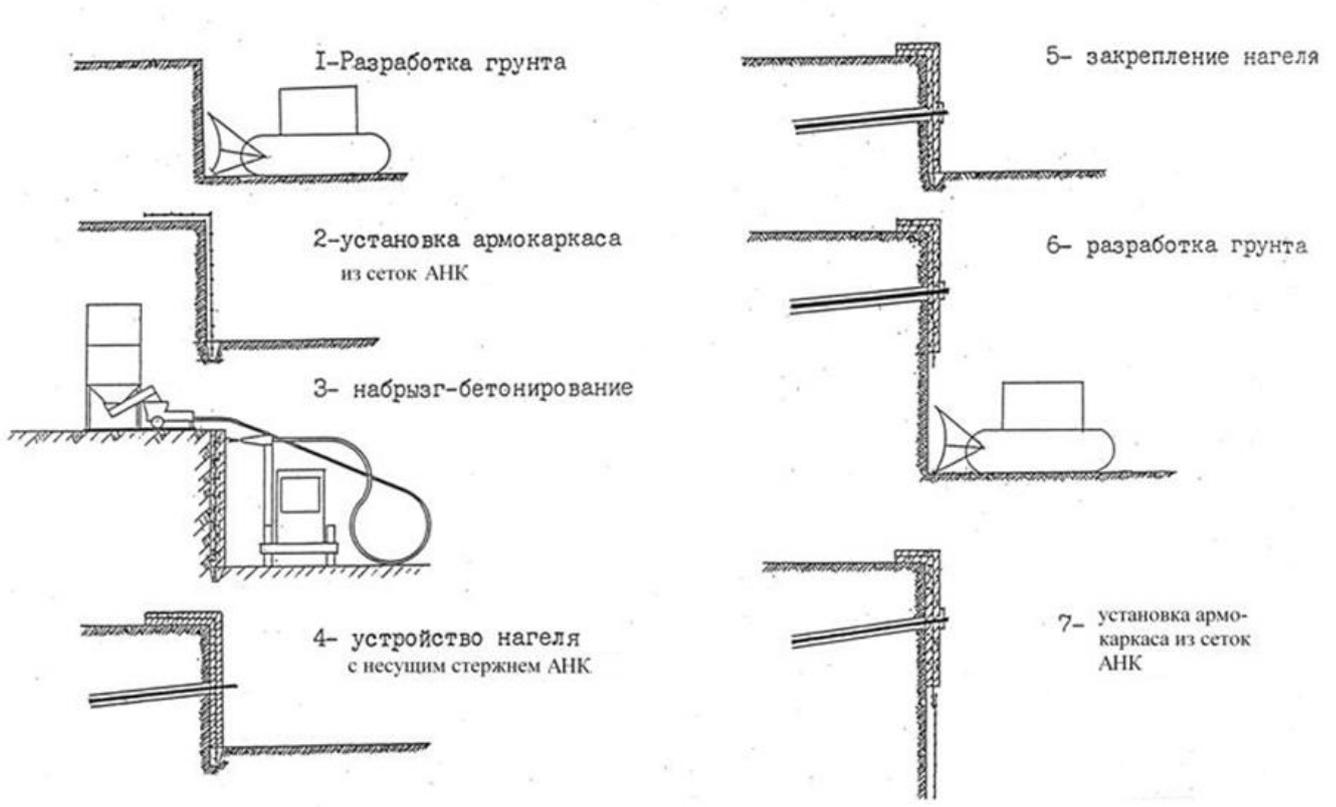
Технология устройства нагельного крепления с набрызг-бетонным экраном и буринъекционным нагелем с несущим стержнем из композитной неметаллической арматуры
